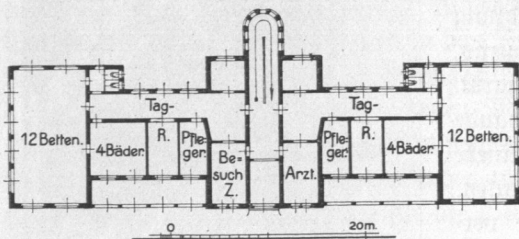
Irrenanstalt Friedrichsberg, Krankengebäude, Erdgeschoss, Grundriß.
